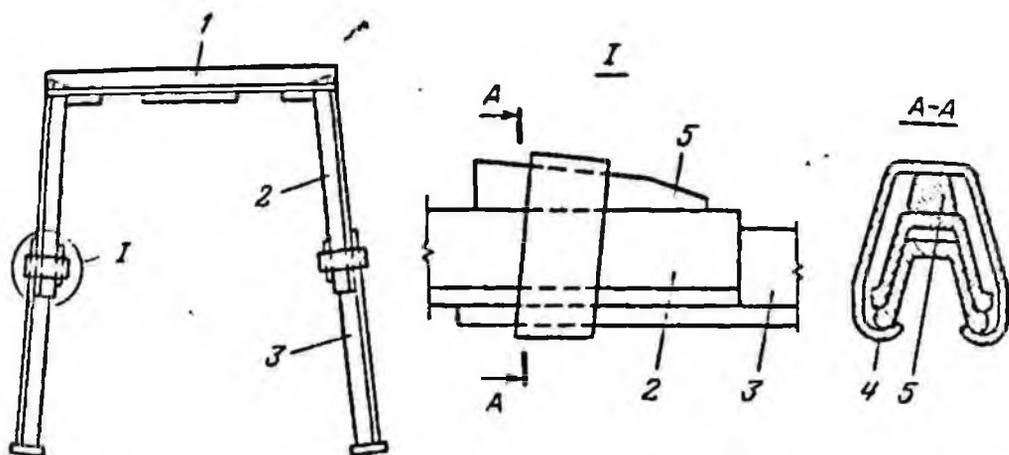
Схема металлической инвентарной крепи МИК-П:
